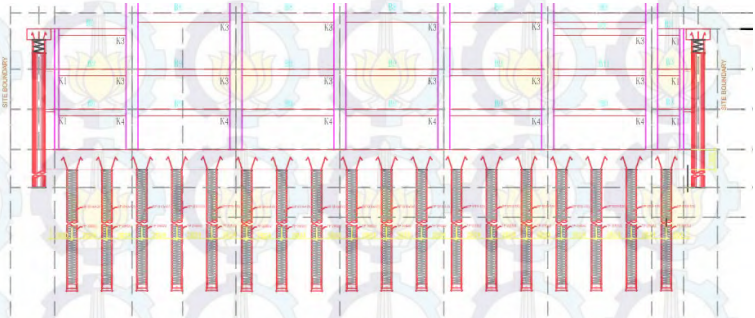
Penggalan Lantai Satu *Basement* pada Zona 1
